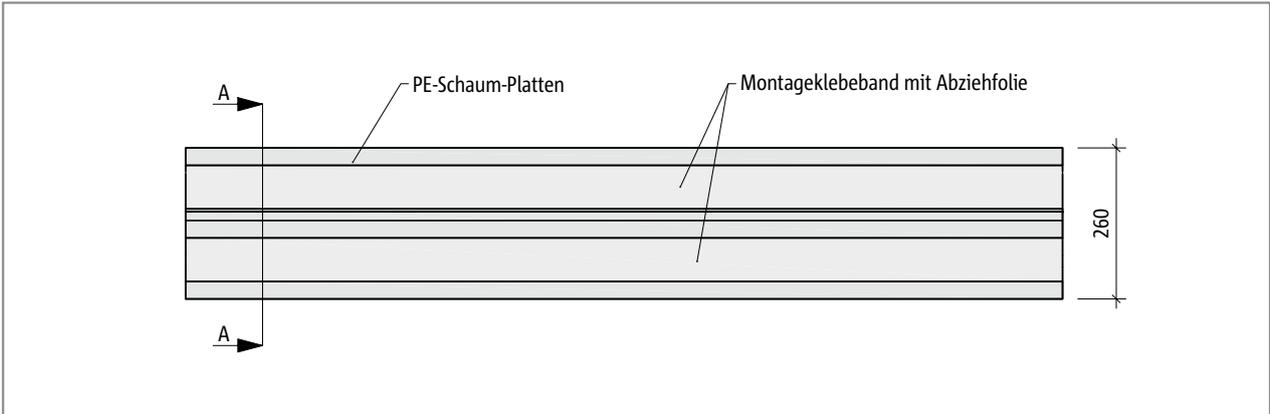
Schöck Tronsole® Typ F: Ansicht
